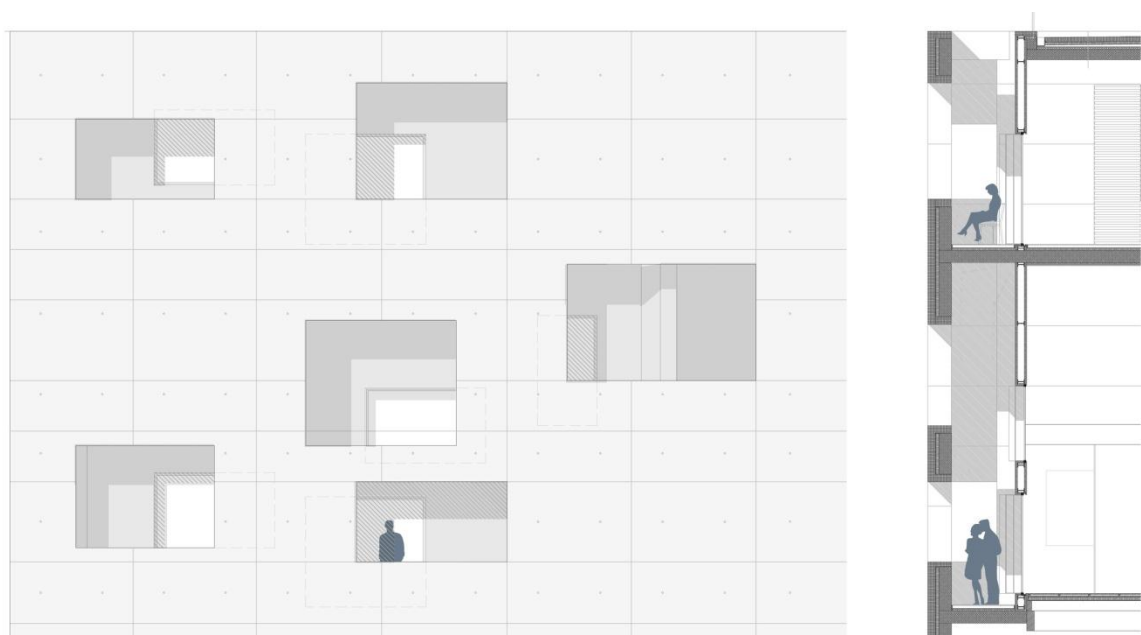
Alçado e secção da fachada de betão onde é possível observar o desencontro entre aberturas;
